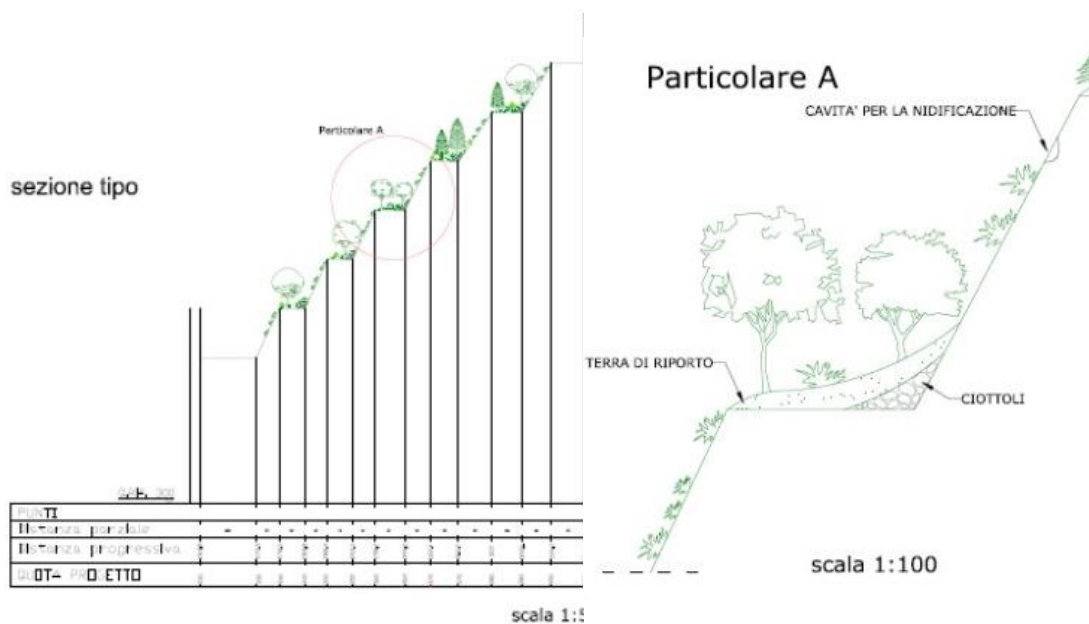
Sezione tipo e particolare (Fonte: Saint Gobain S.p.A.)
